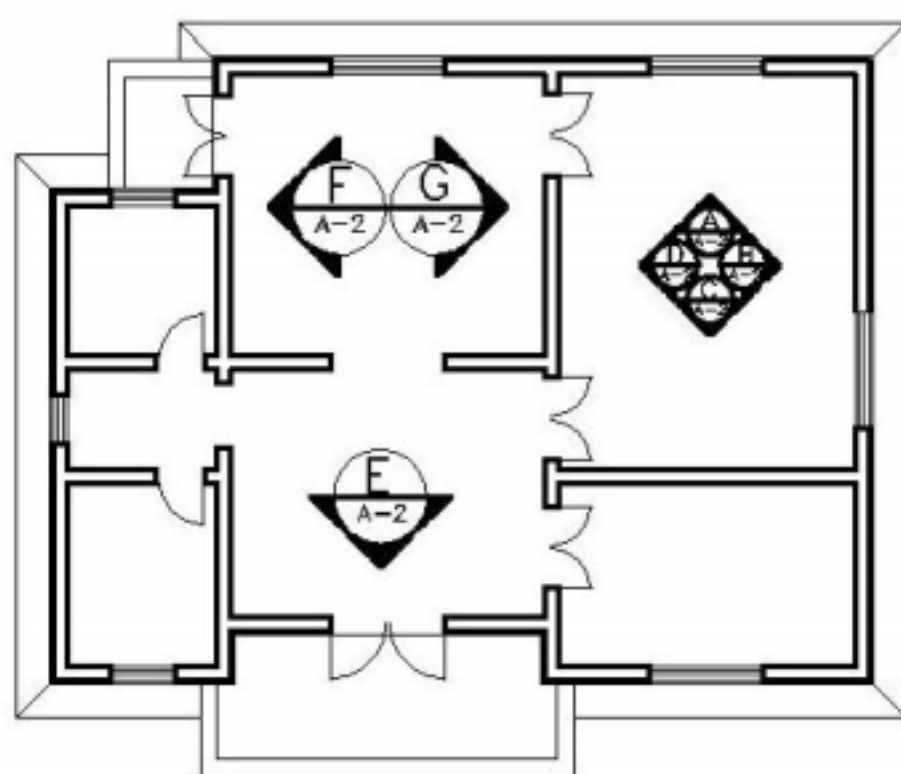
平面图上内视符号（带索引）应用示例
